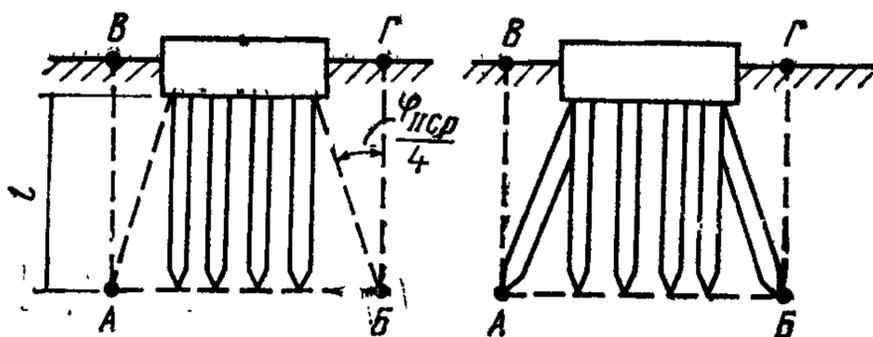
Схема определения границ условного фундамента при расчете осадок свайных фундаментов
